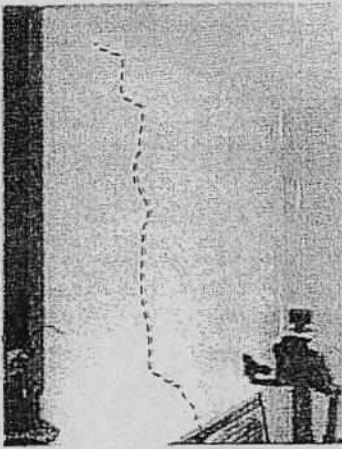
y 58. Fisura en muros interiores y perimetrales apartamento 304 torre costado norte.
